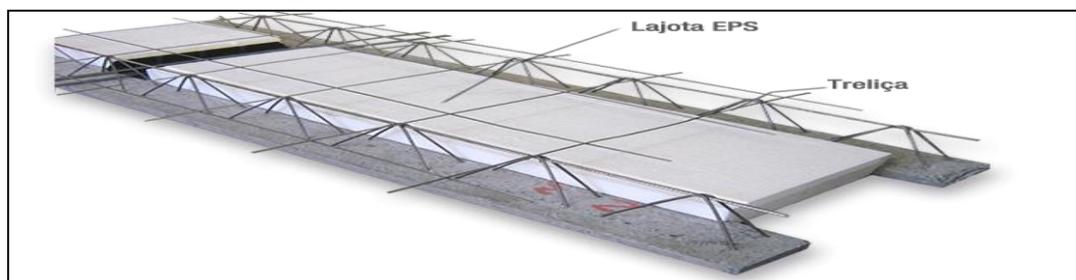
Treliça e lajotas para laje pré-moldada.
